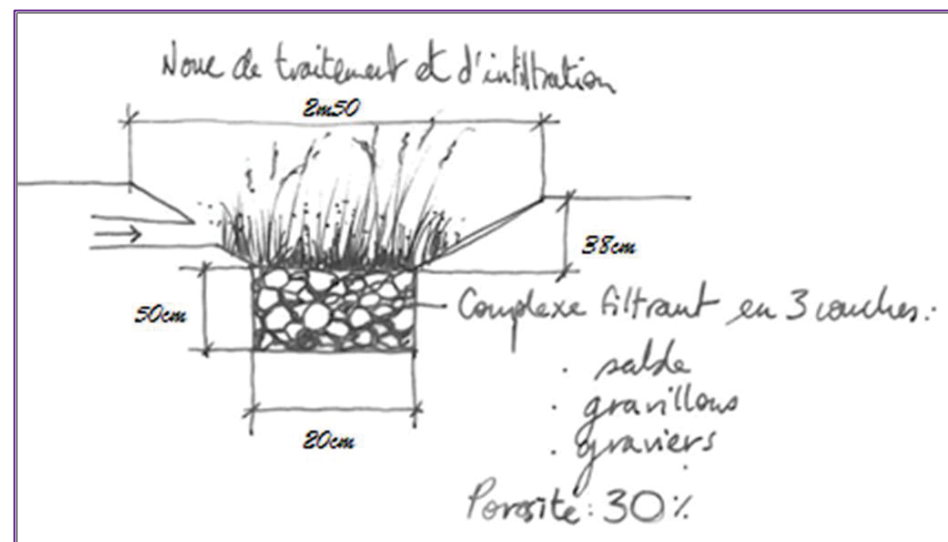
Coupe d'une noue (source : AREP Ville, 2016)
